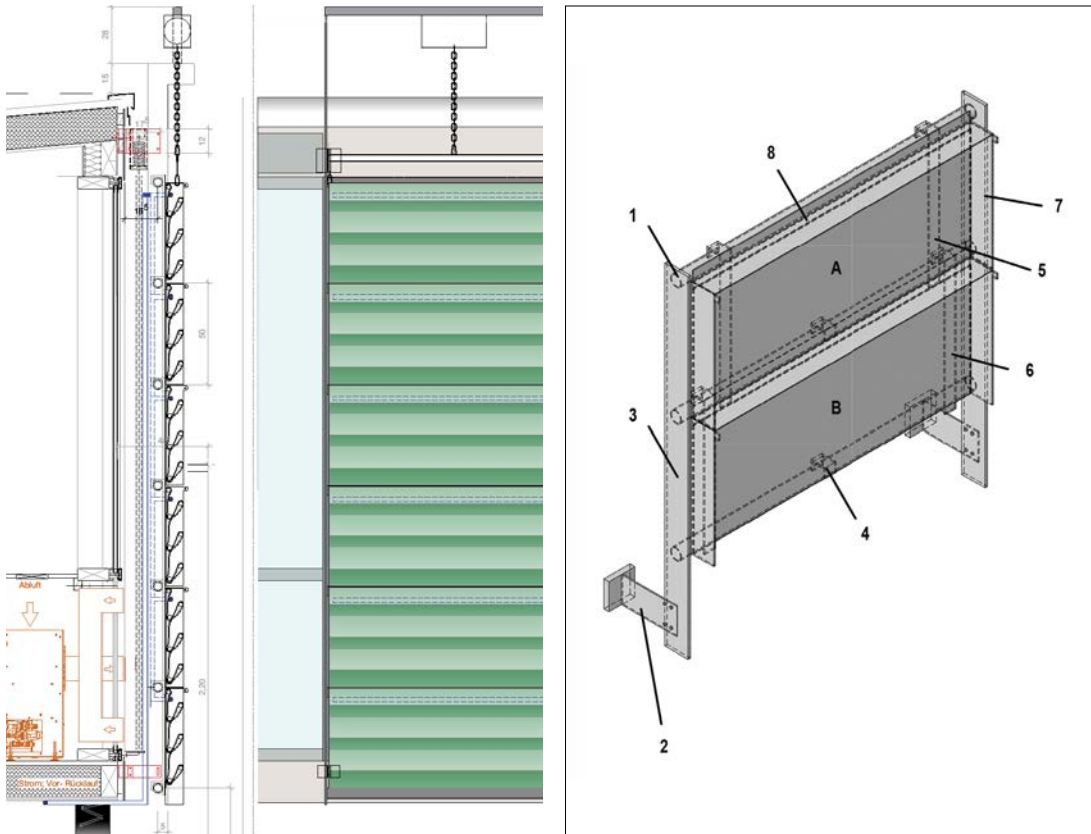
Fassadenversuchsstand – Fassadenaufbau (THN-AR)
